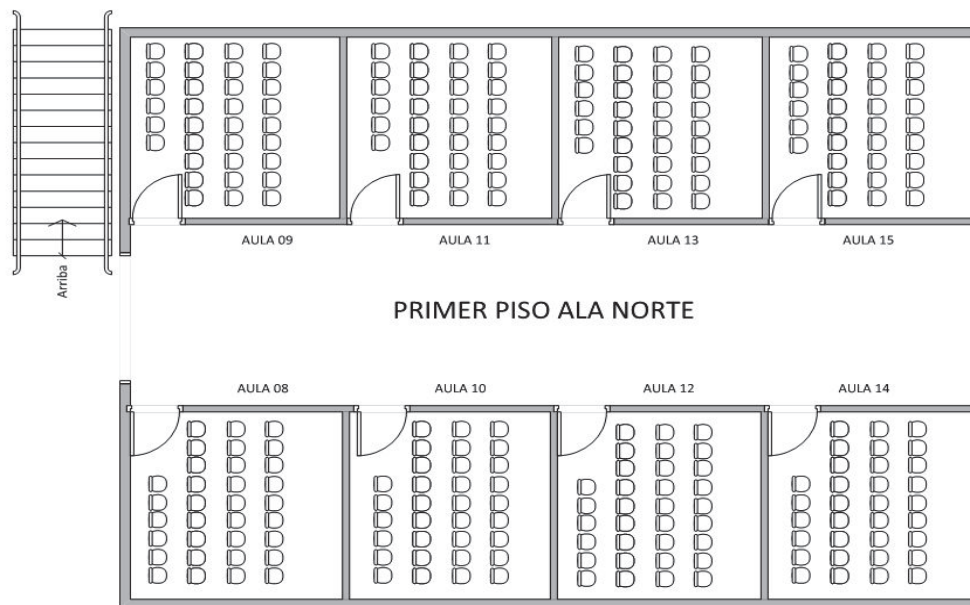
Distribución de las áreas Primer Piso ala norte
